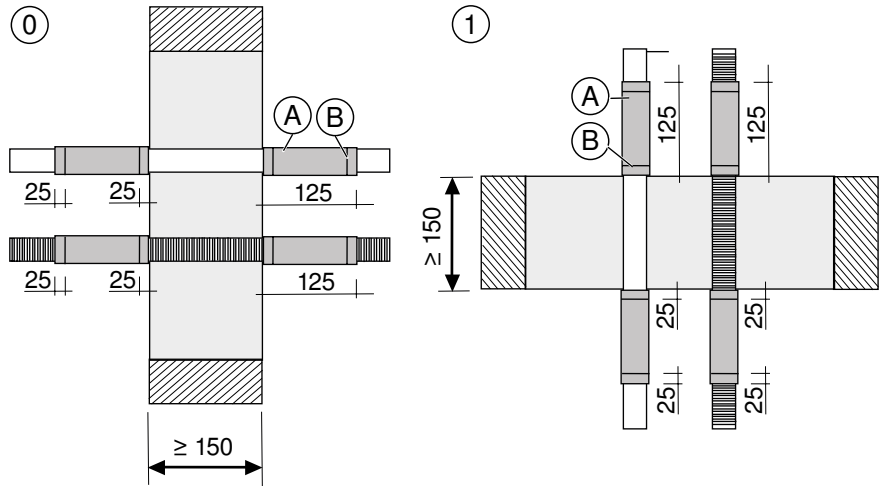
Elektroinstallationsrohren in Wand 0 und Decke 1 mit Brandschutzwickel
